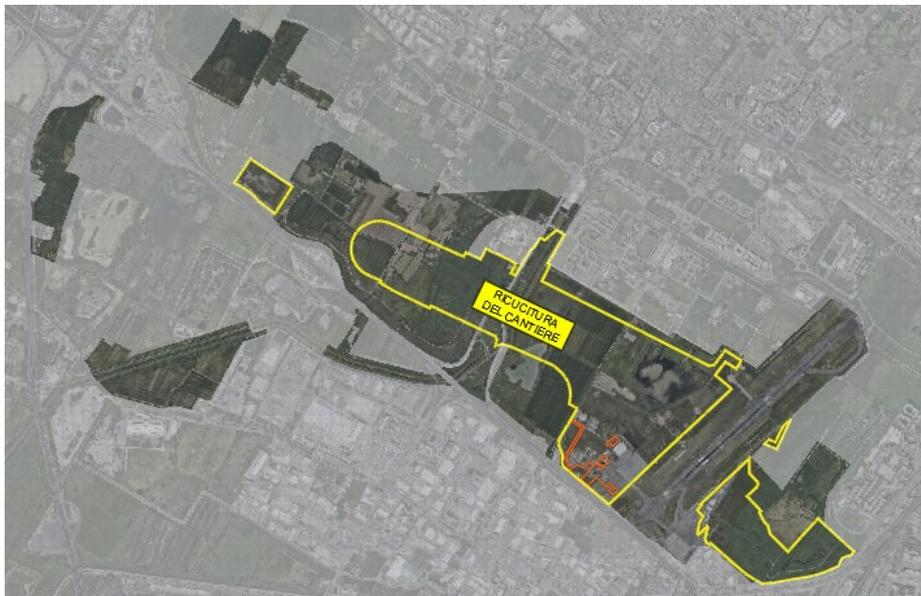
Planimetria di cantierizzazione: ricucitura macro lotti
